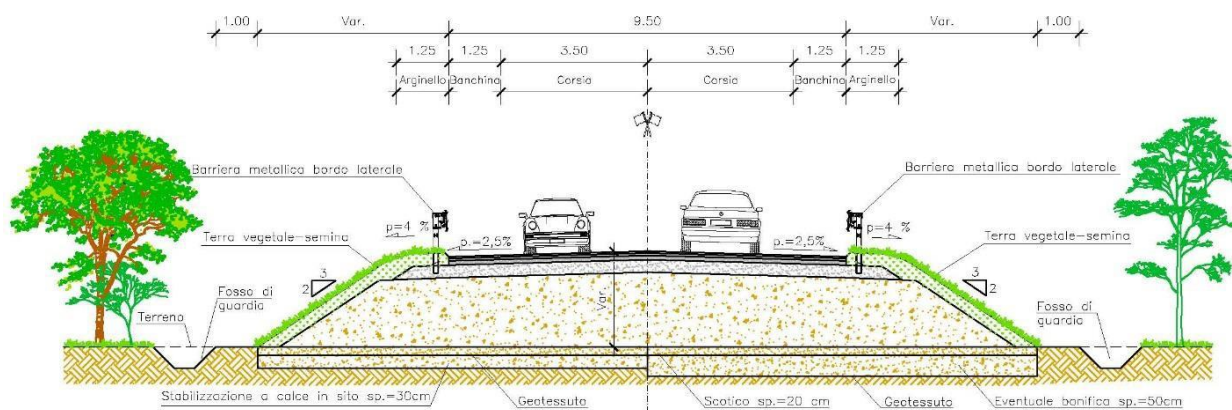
Sezione tipo C2 in rettilineo attraversamento abitato di Tai di Cadore
